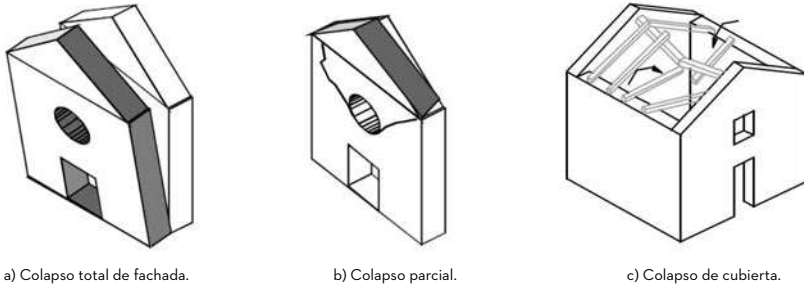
FALLAS TÍPICAS EN MAMPOSTERÍA POR SISMO EN EL PLANO
